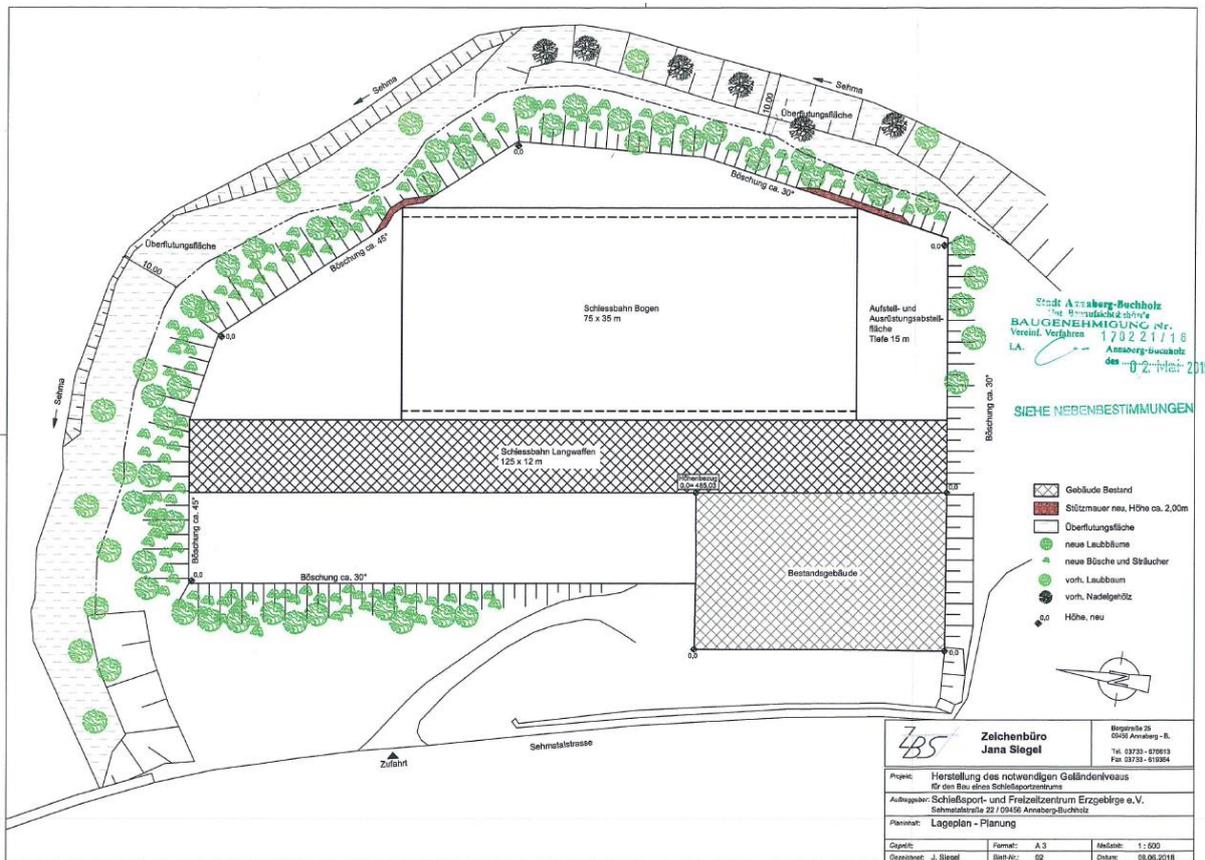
Lageplan der Schießsportanlagen und gewässernahen Bereiche.
